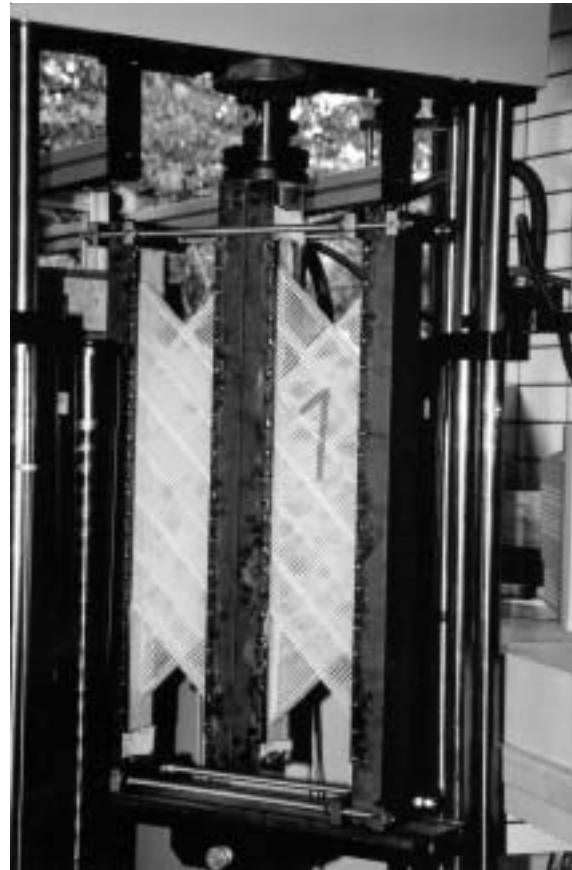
Schubprüfung an einer zweilagigen ±45° PEKATEX®-Stegkonfiguration
